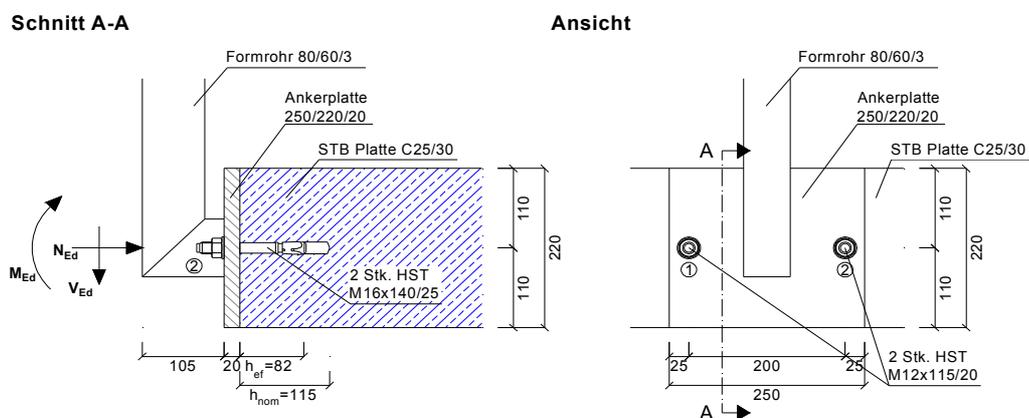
Anschlussdetail G3 Dübel Variante 2 (Maße in mm)
